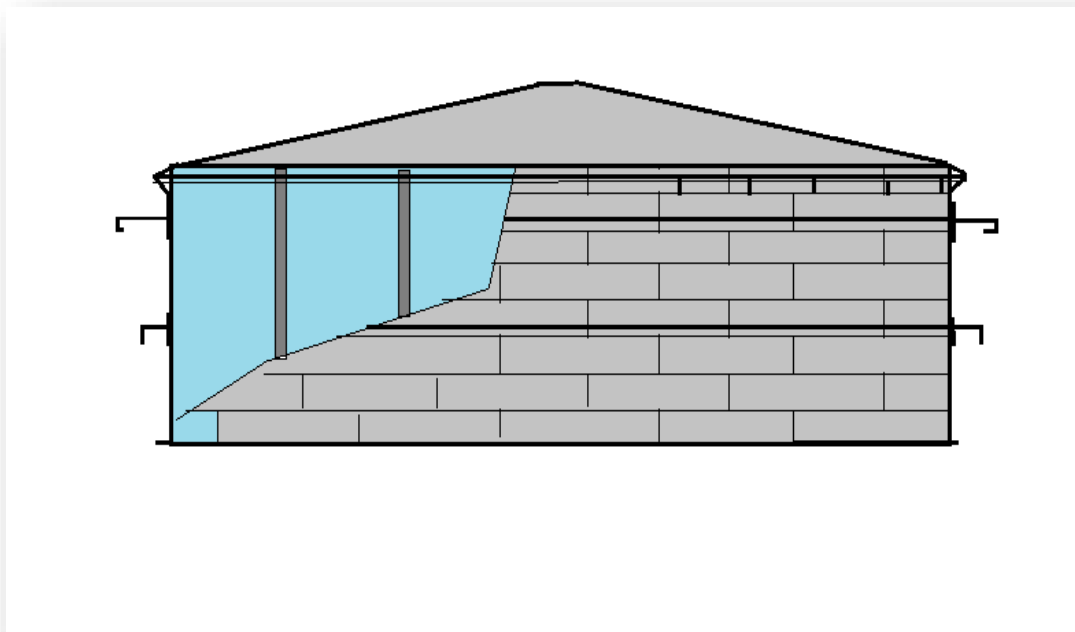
Position de la poutre au vent et Poutre raidisseuse intermédiaire sur robe
